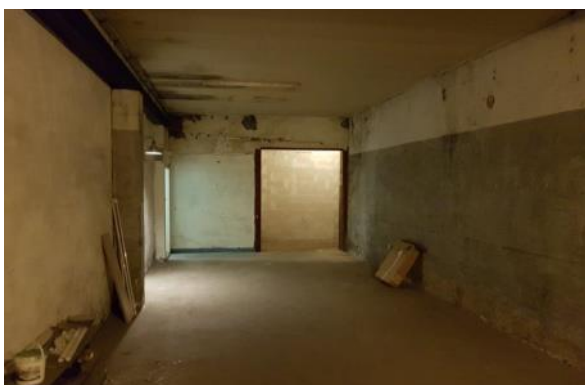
Ruimte in het hoofdgebouw (leegstand)
